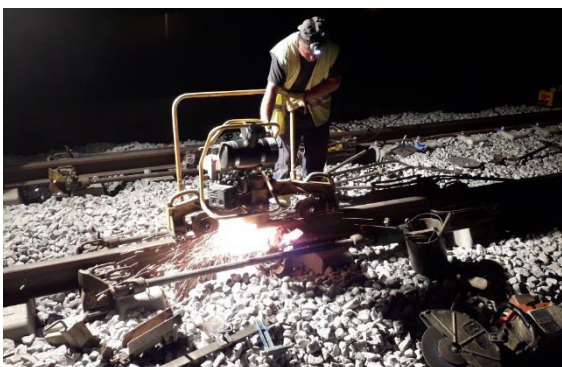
Reperfilamento da cabeça do carril com esmeriladora ligeira
